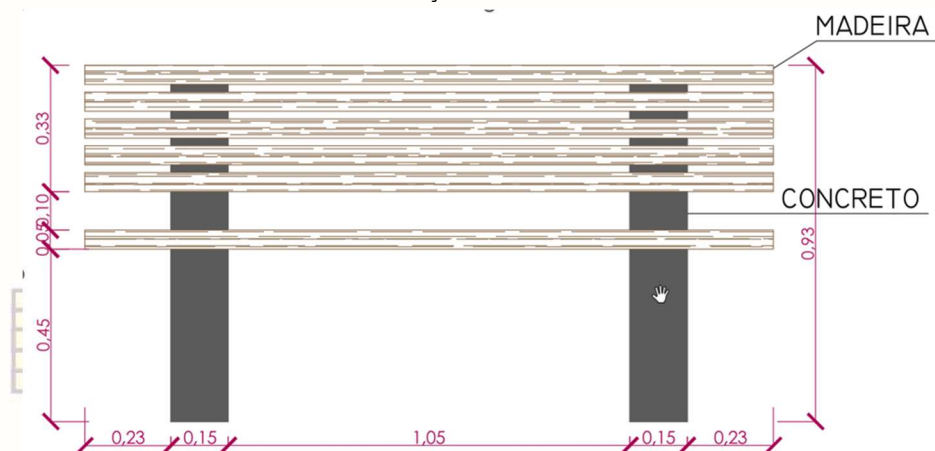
Vista frontal do banco que deverá ser produzido pela empresa prestadora de serviços.
